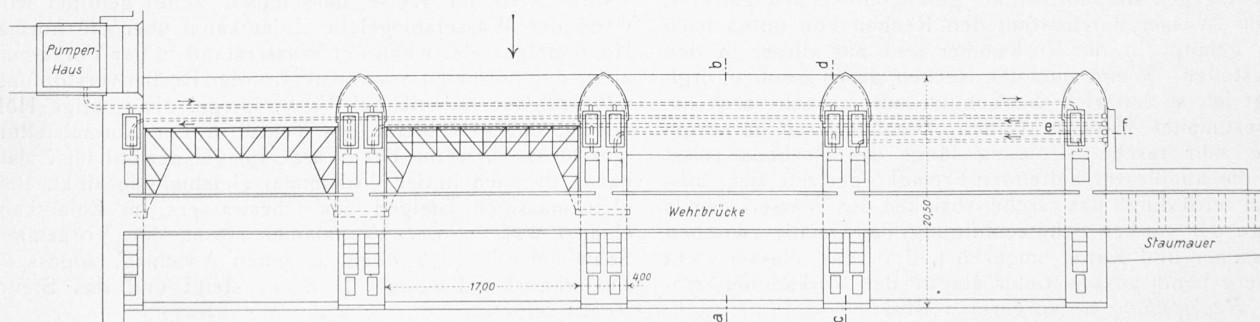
Stauwehr im Sele, Grundriss der vier Wehröffnungen mit den automatischen Segmentschützen. — Masstab 1 : 600.
